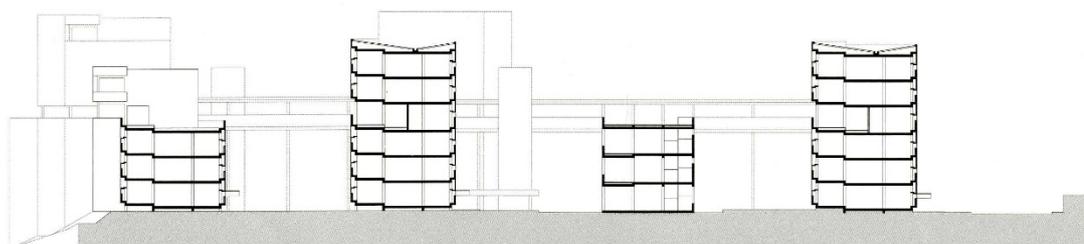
Plano accesos a galería y sección de conjunto. 1964. Fuente: Oscar Corbelle sobre plano base extraído de libro: *Vivenda colectiva, vivienda protegida. Social housing in Galicia.* (Antonio García, Yolanda Somoza)
